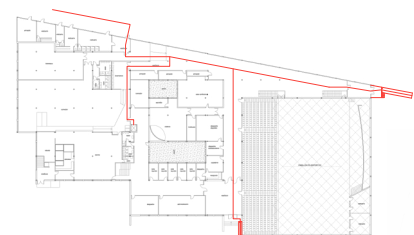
Accesibilidad propuesta planta baja pabellón E.
